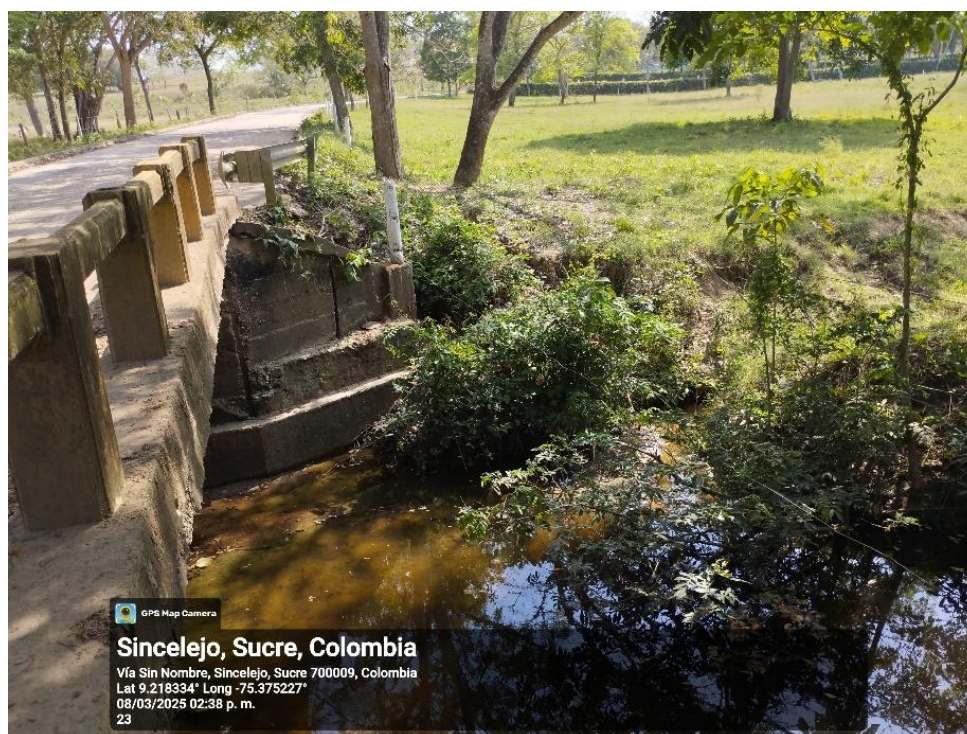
Grietas en aletas, muros. Pontón K3+613. Fuente Inspección en la vía
